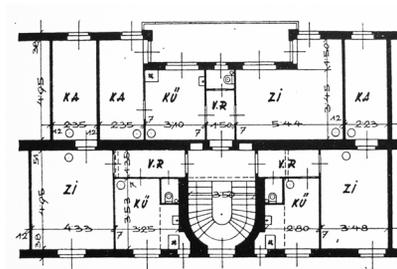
Karl-Marx-Hof, Grundrisstyp
